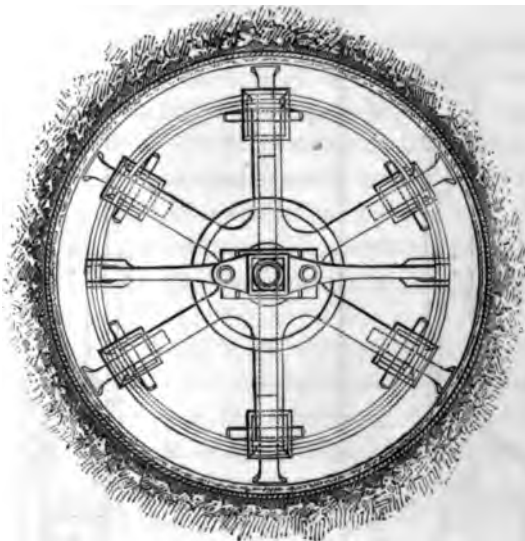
Plan du trépan Degousée et Laurent (Puits de La Chapelle).
